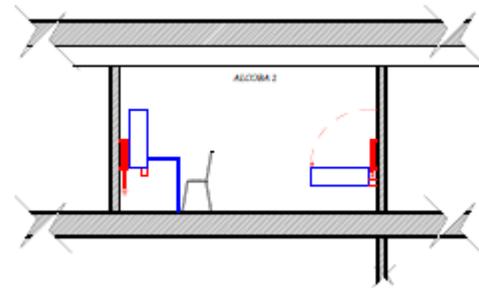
Corte del plano, funcionamiento de las Wall beds.
